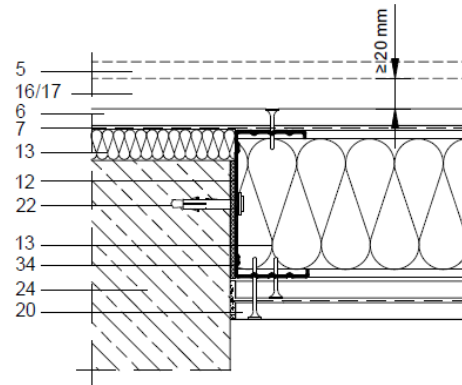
Encuentro con pilar del sistema Aquapanel® WM111C.
